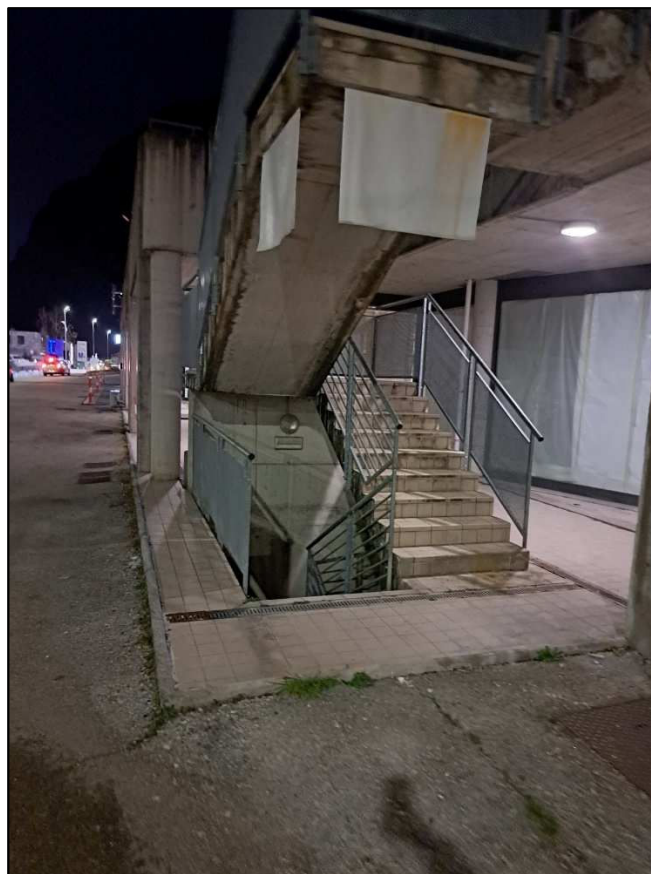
scala ovest di collegamento fra il piano sottostrada, il cortile ovest (a piano terra) e il lastrico solare a piano primo.
